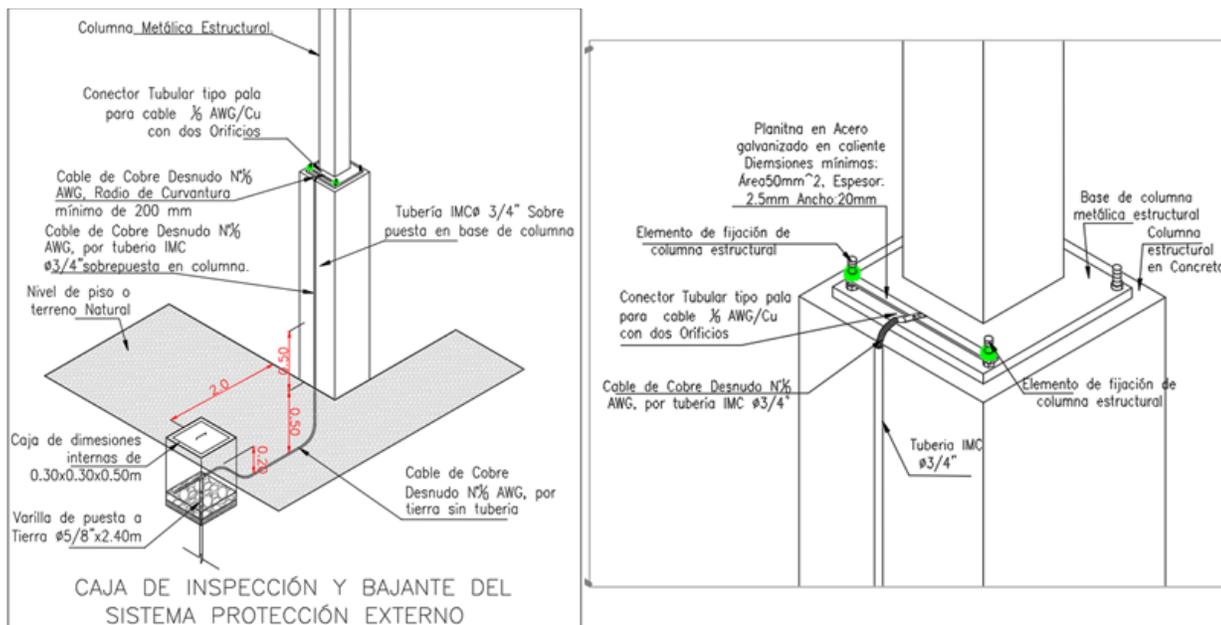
Conexi3n entre el bajante y la puesta a tierra.
